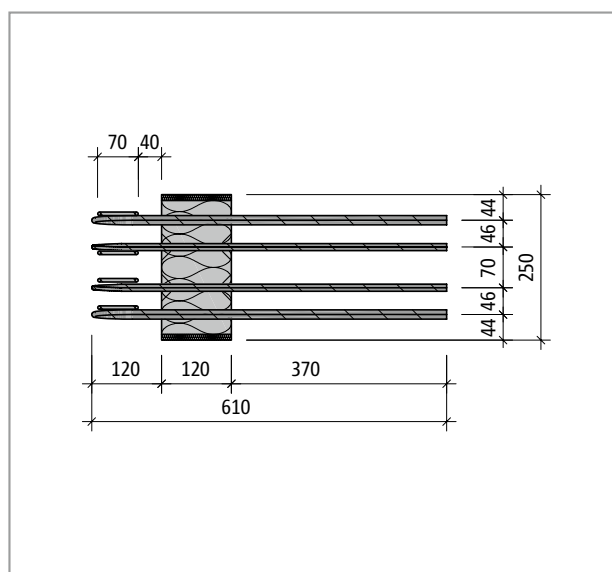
Schöck Isokorb® XT type F: Product plan view
